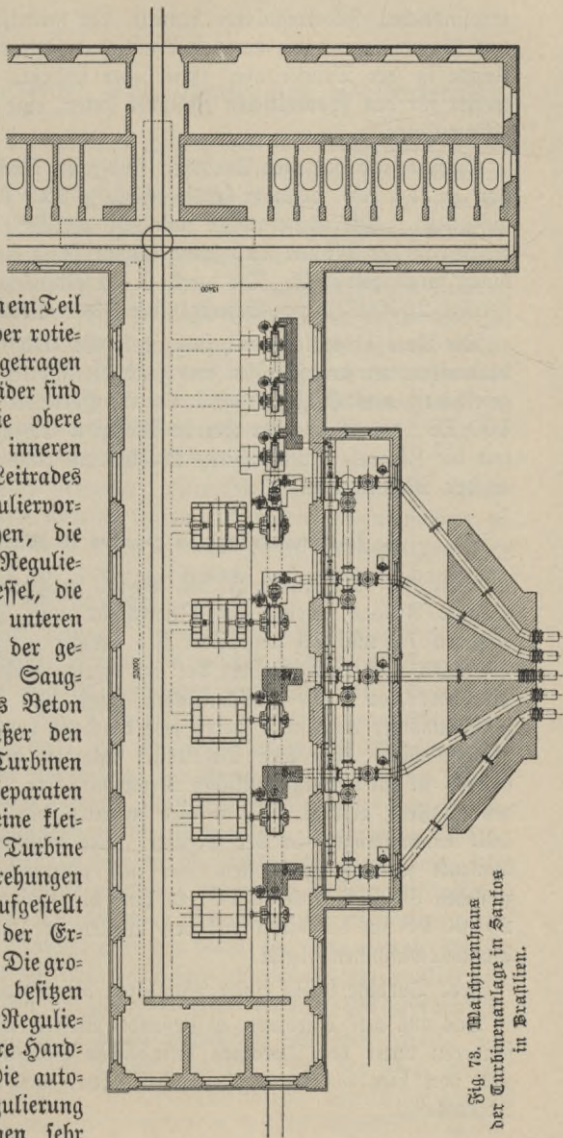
Maschinenhaus der Turbinenanlage in Santos in Brasilien.
